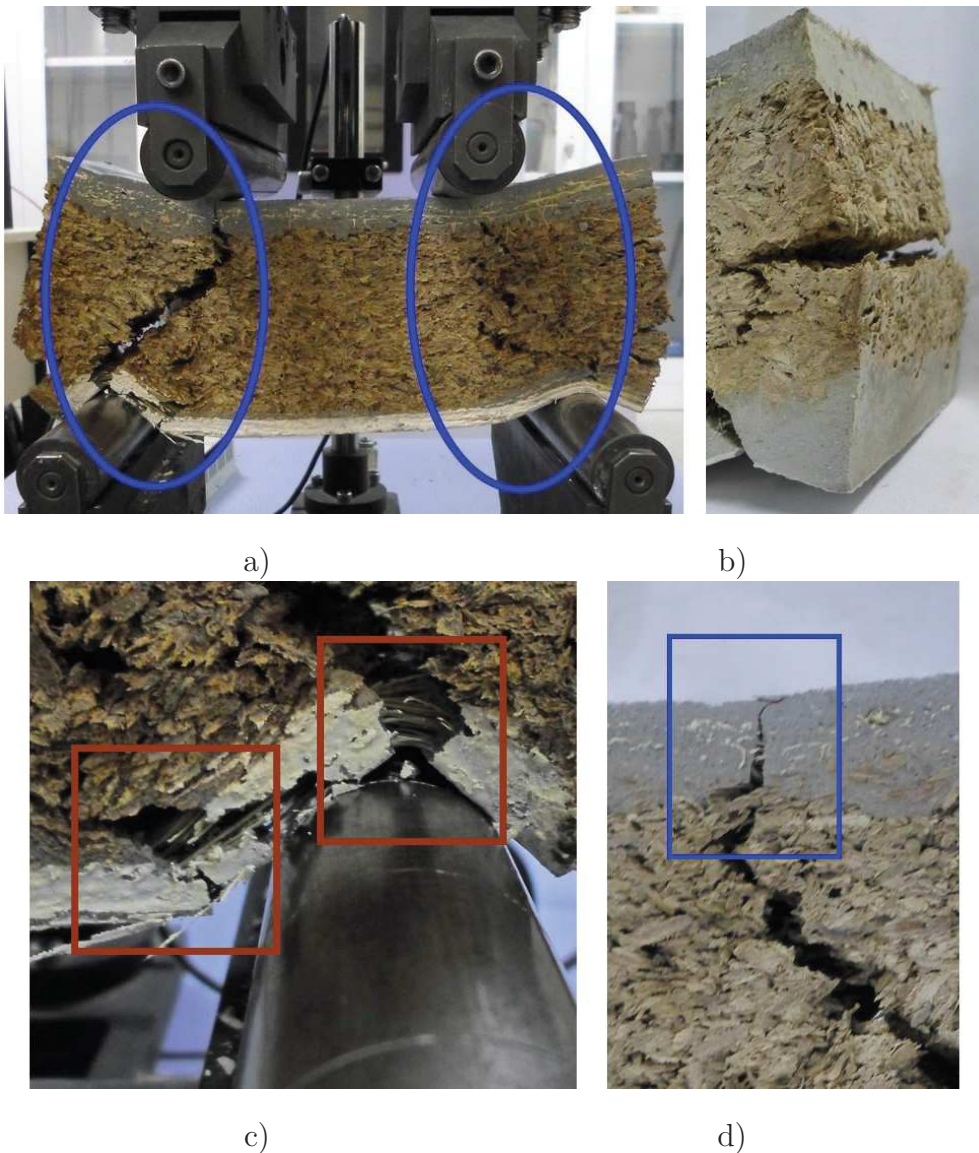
Localizações de fissuras no PS 0,5 a,b) núcleo c,d)faces
